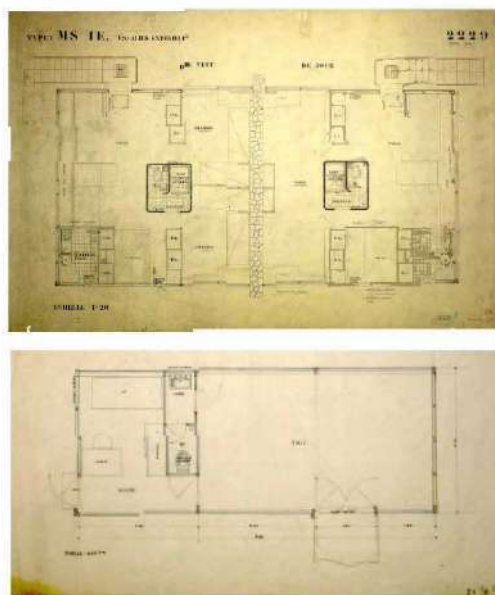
Planta casas Loucheur e Planta Pavilhão S.T.A.R. Fonte: Fundação Le Corbusier
